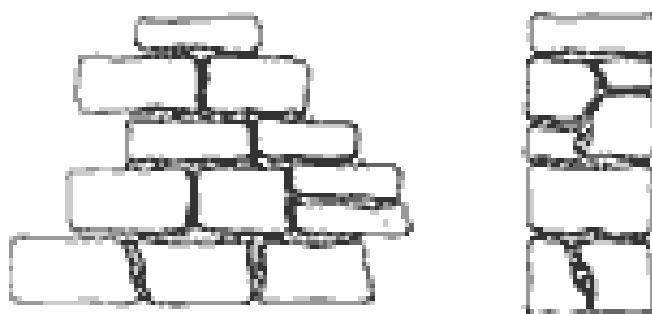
Esquema construtivo de parede de pedra com aparelhamento - Pedras com aparelho parcial dispostas em camadas
